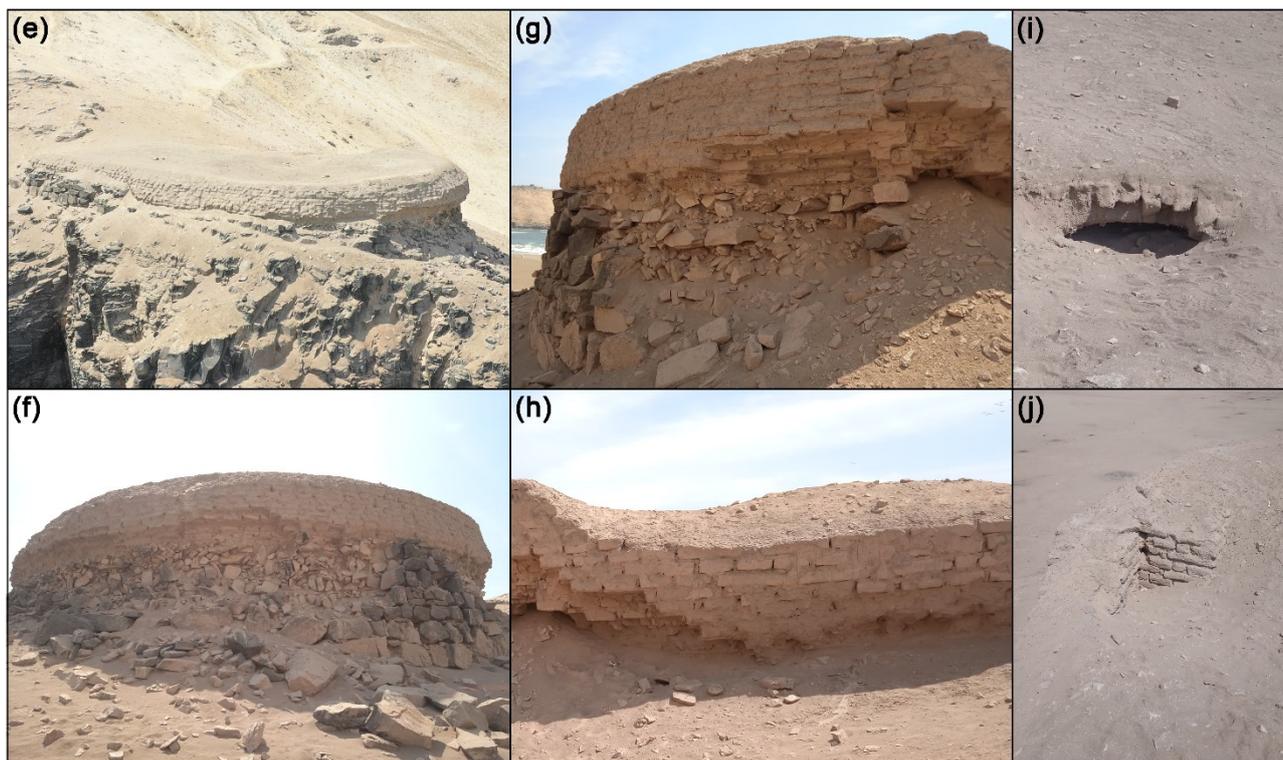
Vistas de: e) la ubicación de la batería de costa sobre lo alto del acantilado; f) el sólido sobrecimiento de mampostería de piedra y la plataforma de adobe de la batería; g) la erosión del sobrecimiento y la plataforma de la batería, llegando al punto de desprendimiento de piedras y adobes; h) la variación de la altura del sobrecimiento y de la plataforma de la batería; i) una bóveda en el interior de la plataforma de la batería, la cual aún permanece enterrada e inexplorada; j) la presencia de una estructura dentro de la plataforma de la batería, acompañada por lamentables marcas de vandalismo escritas sobre los bloques de adobe.
